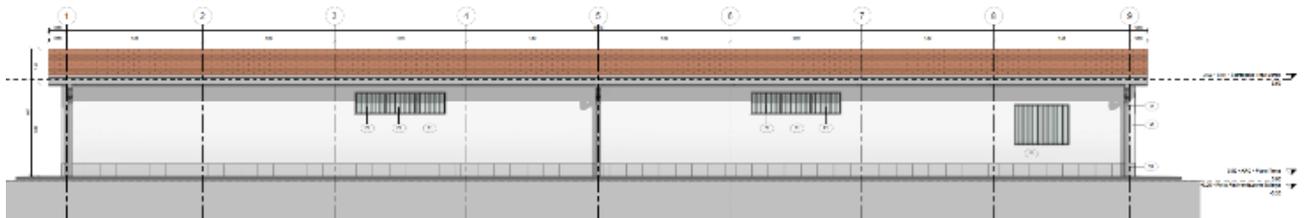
PM Turago – Prospetto Ovest (Opposto ai Binari)
